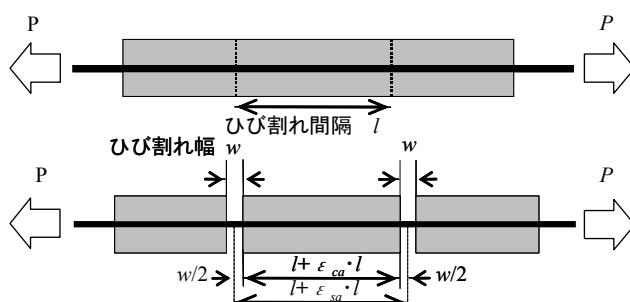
鉄筋コンクリート部材のひび割れ幅
